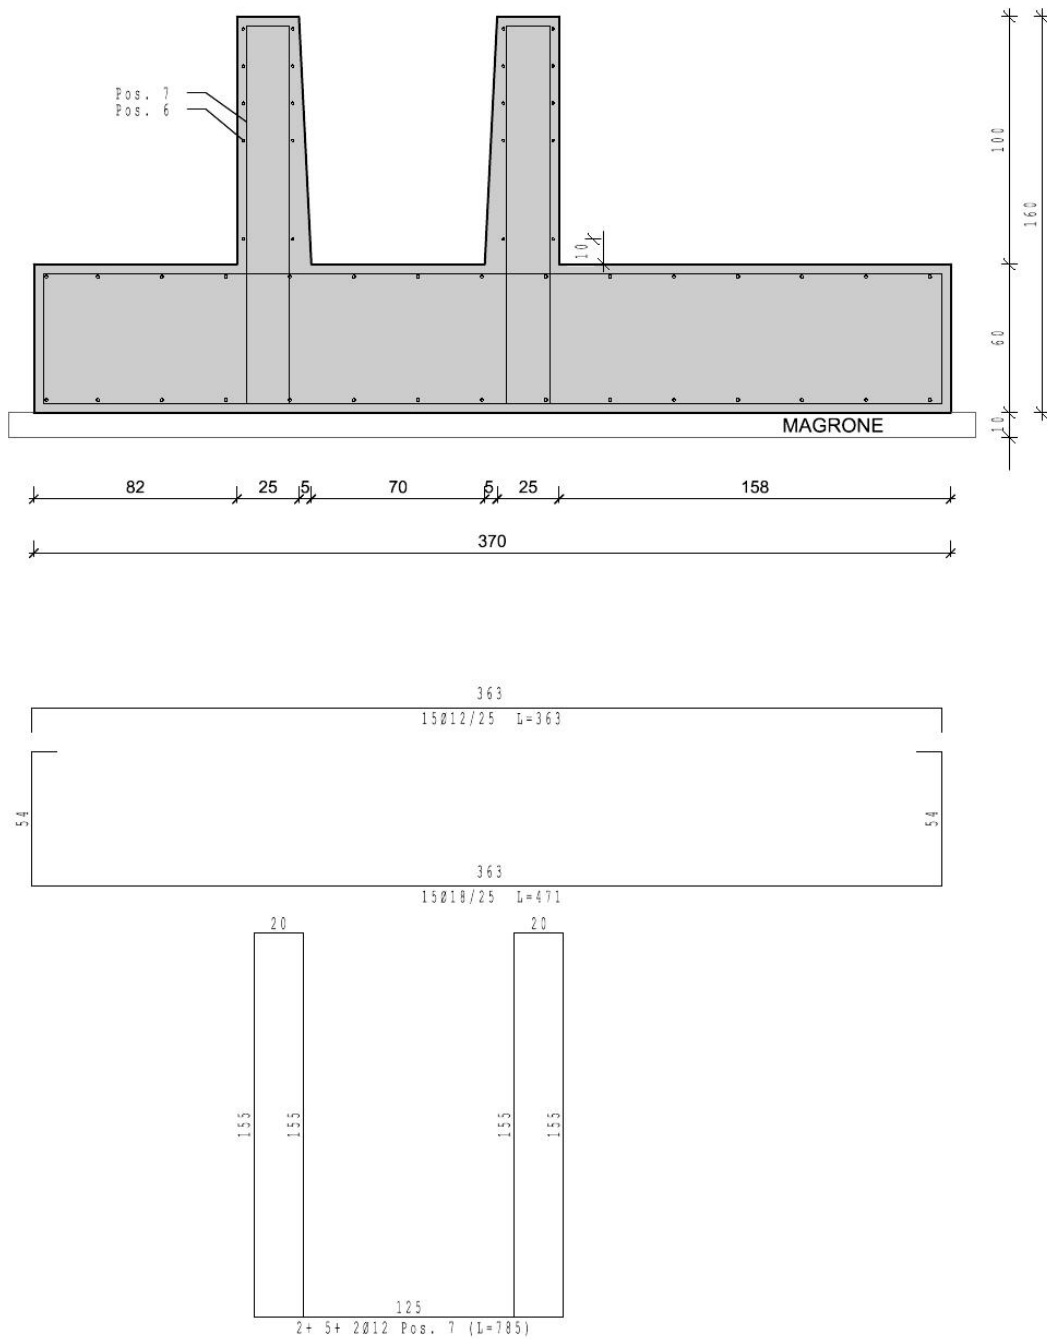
Particolare di A.2003.cap.us.T04 - Particolari plinti 8 e 9 - Sezione tipo plinto 9
